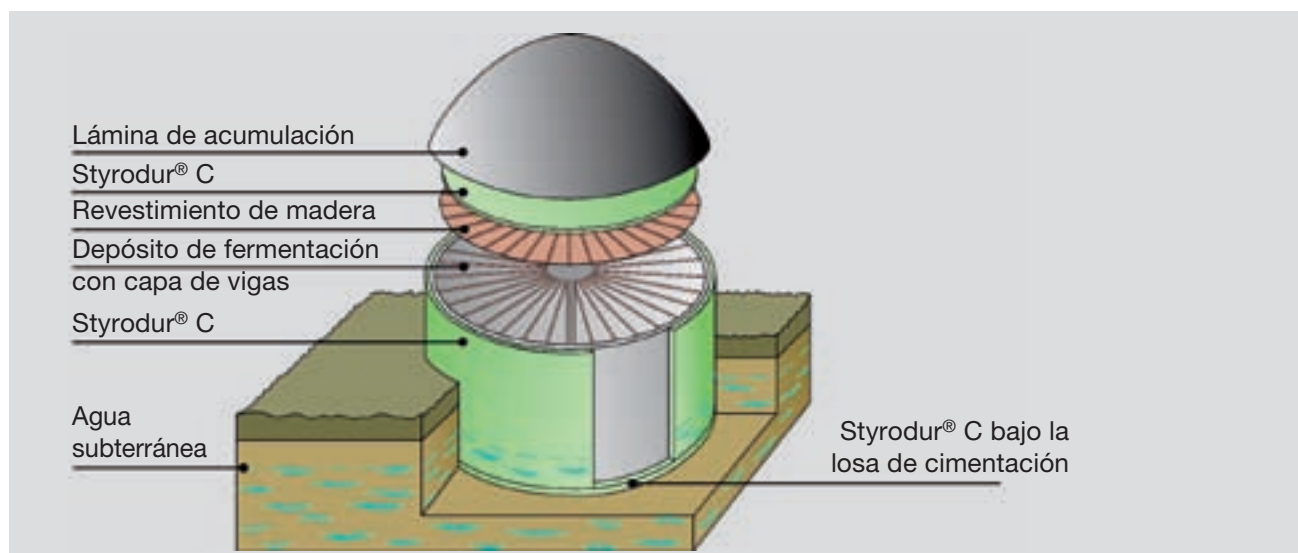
Representación esquemática de un depósito de fermentación con cubierta de lámina.
